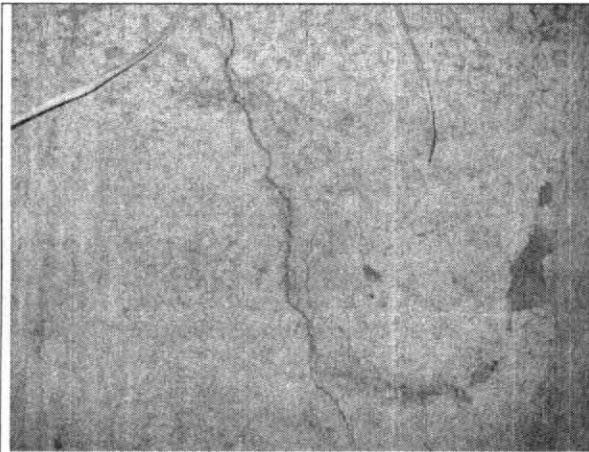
Fisura del pañete de recubrimiento del muro lateral.
